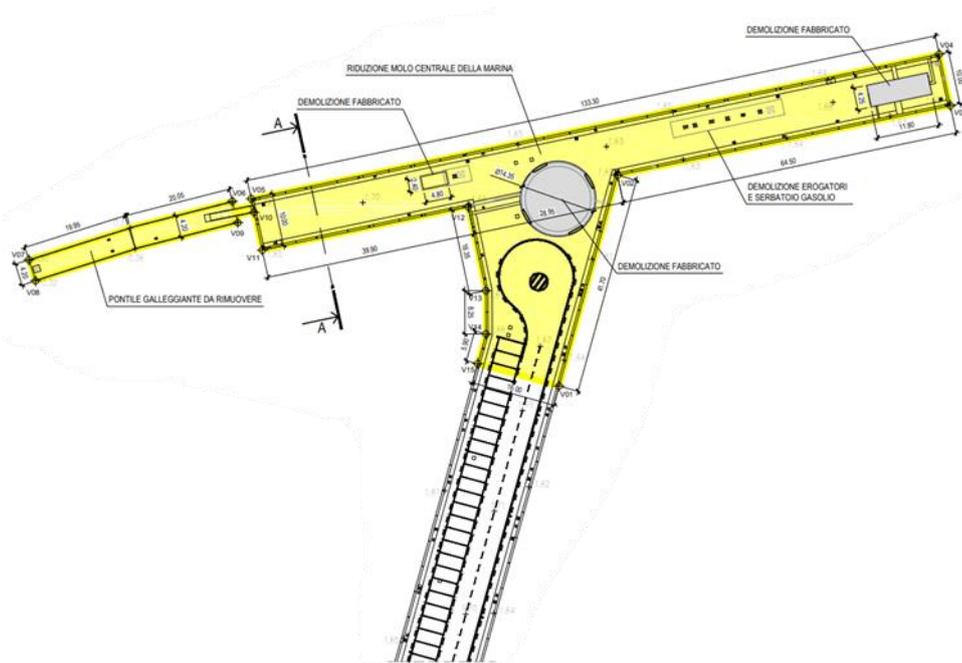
Planimetria del molo centrale con indicazione delle aree da demolire
